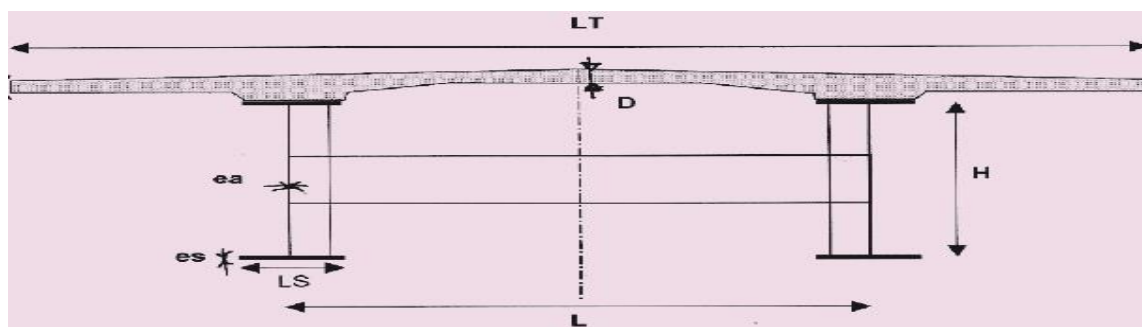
Paramètres du dimensionnement d'un bipoutre à entretoises.
